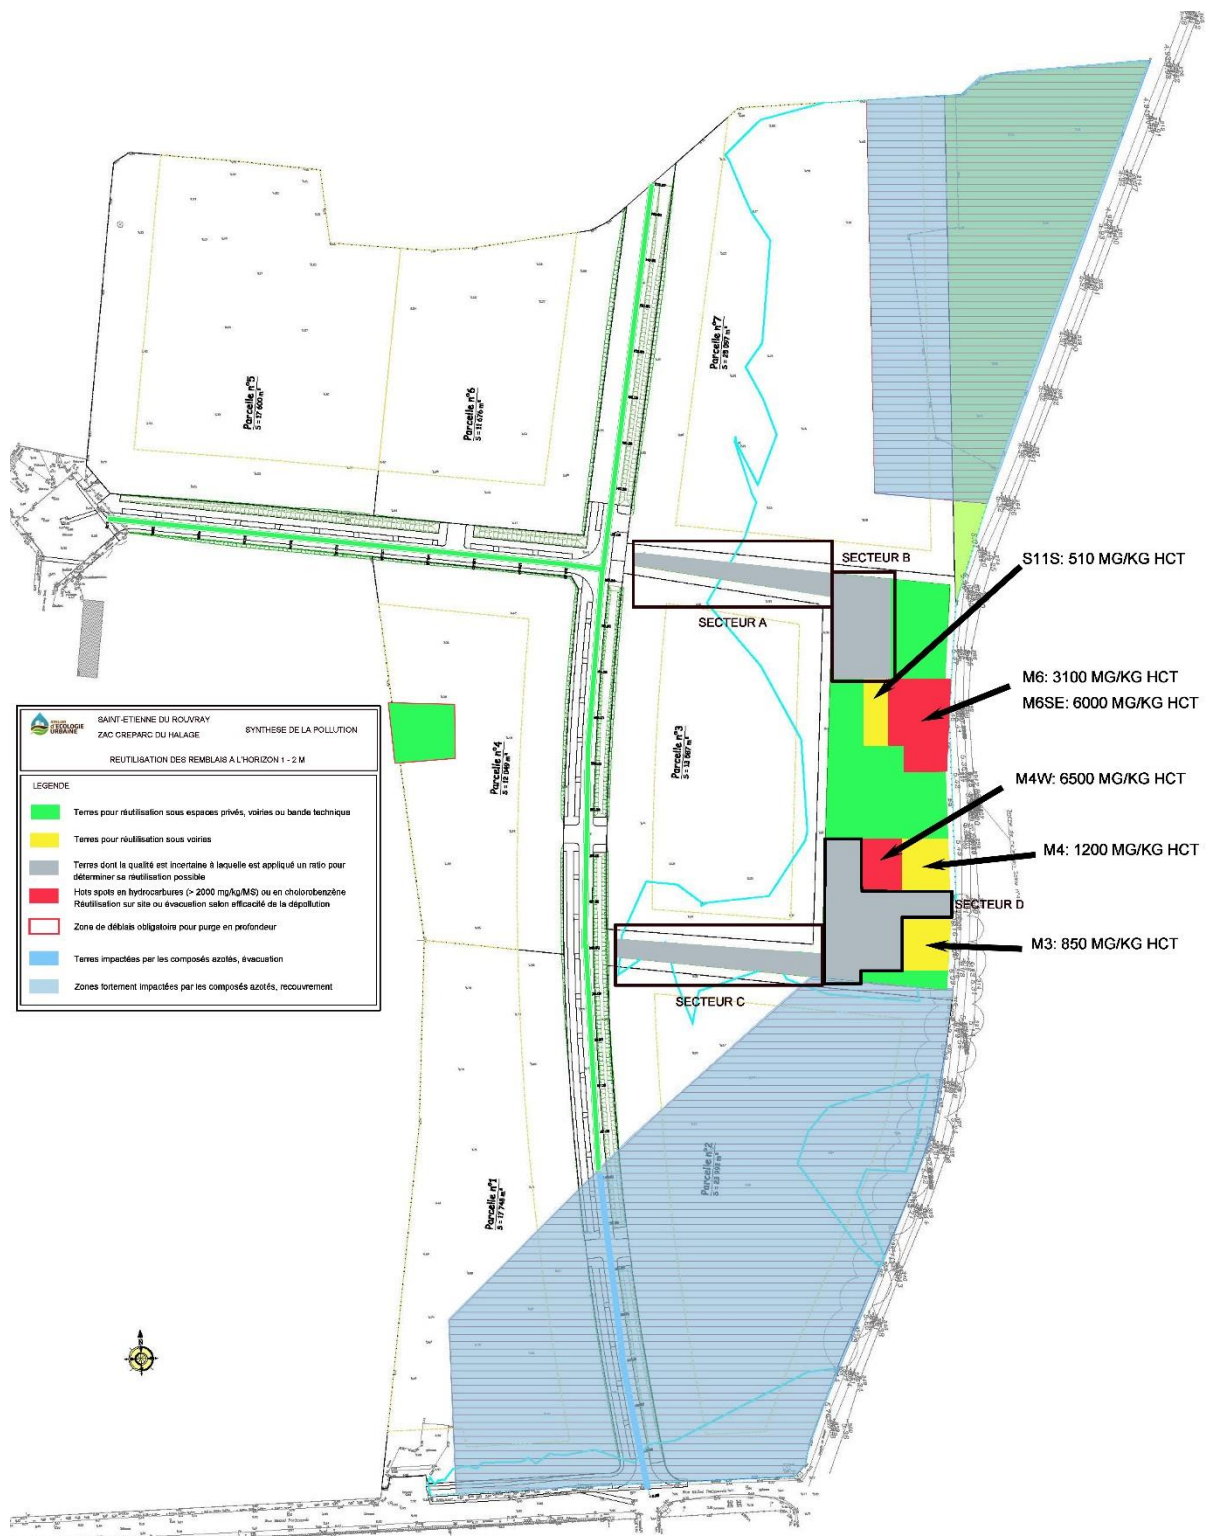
Terrassement et purges sur la profondeur 1-2m
